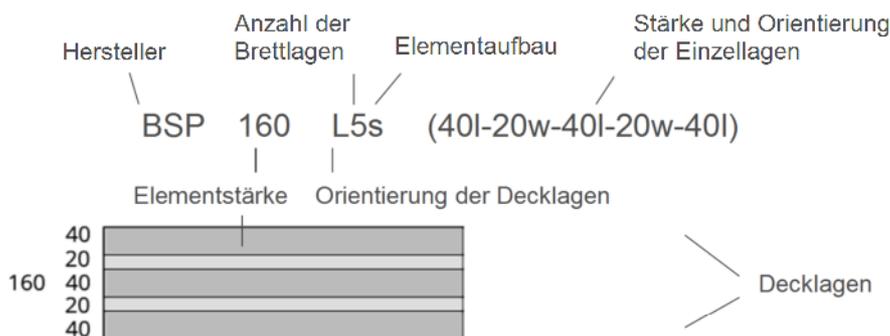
Bezeichnungsschema für den Aufbau von Brettsperrholz-Elementen
